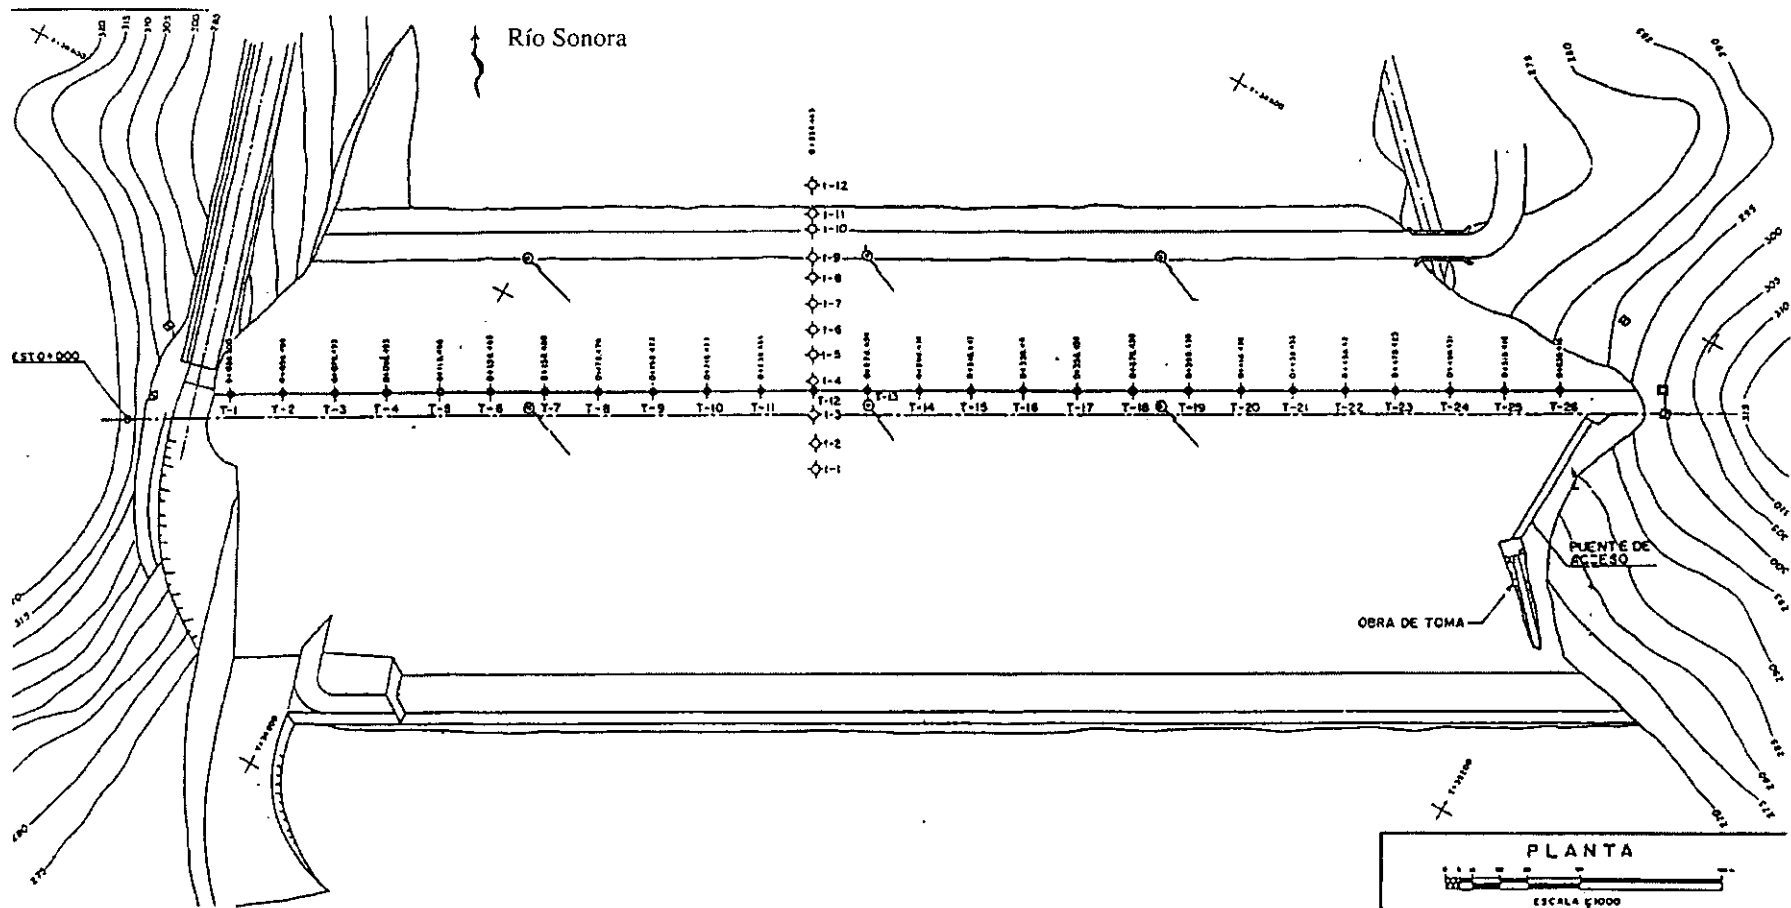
Localización de instrumentos en la cortina. Vista en planta
